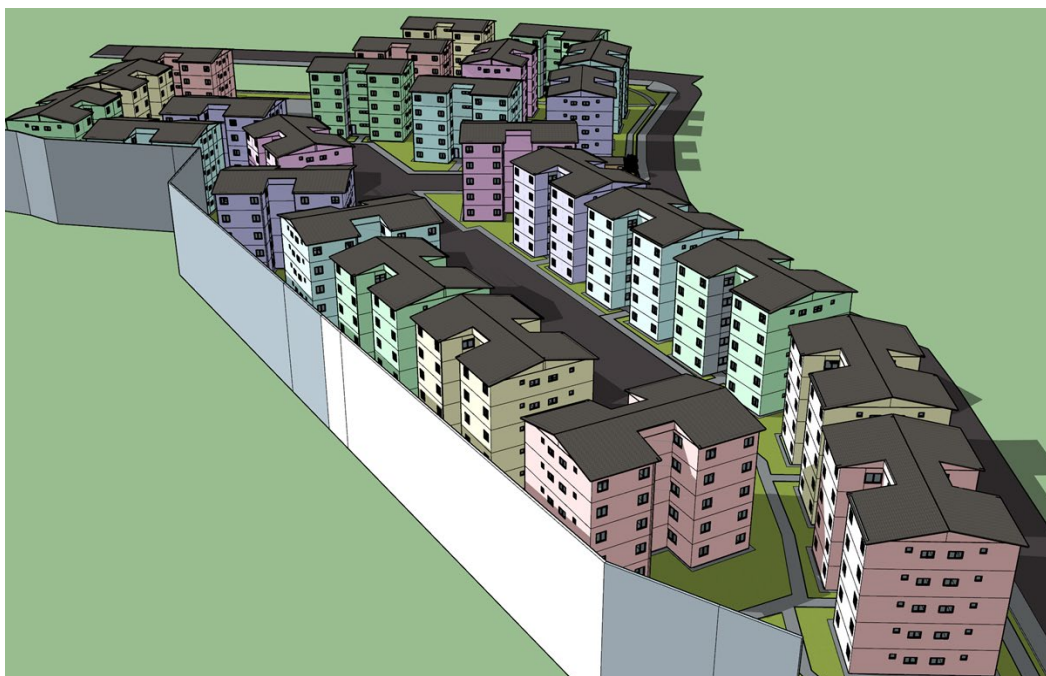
Vista perspectivada fachadas sul – Cond. Ismael Silva - Fev- 15:30
